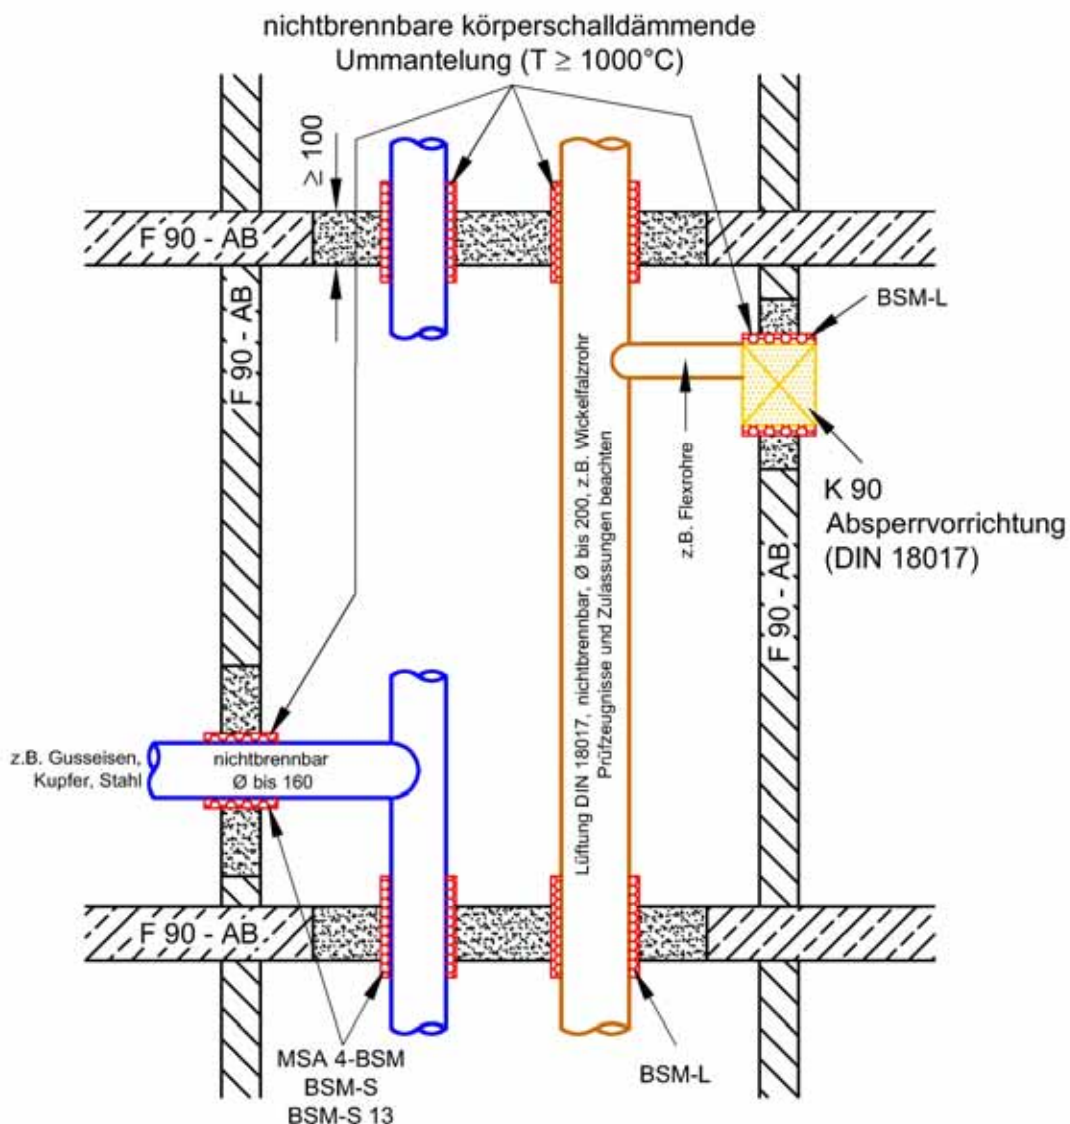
Installation von nicht brennbaren Sanitär-, Heizungs- und Lüftungsleitungen mit nicht brennbaren Dämmungen in einem F90-Installationsschacht nach DIN 4102-4 für F90-, F60- und F30-Rohrdurchführungen
